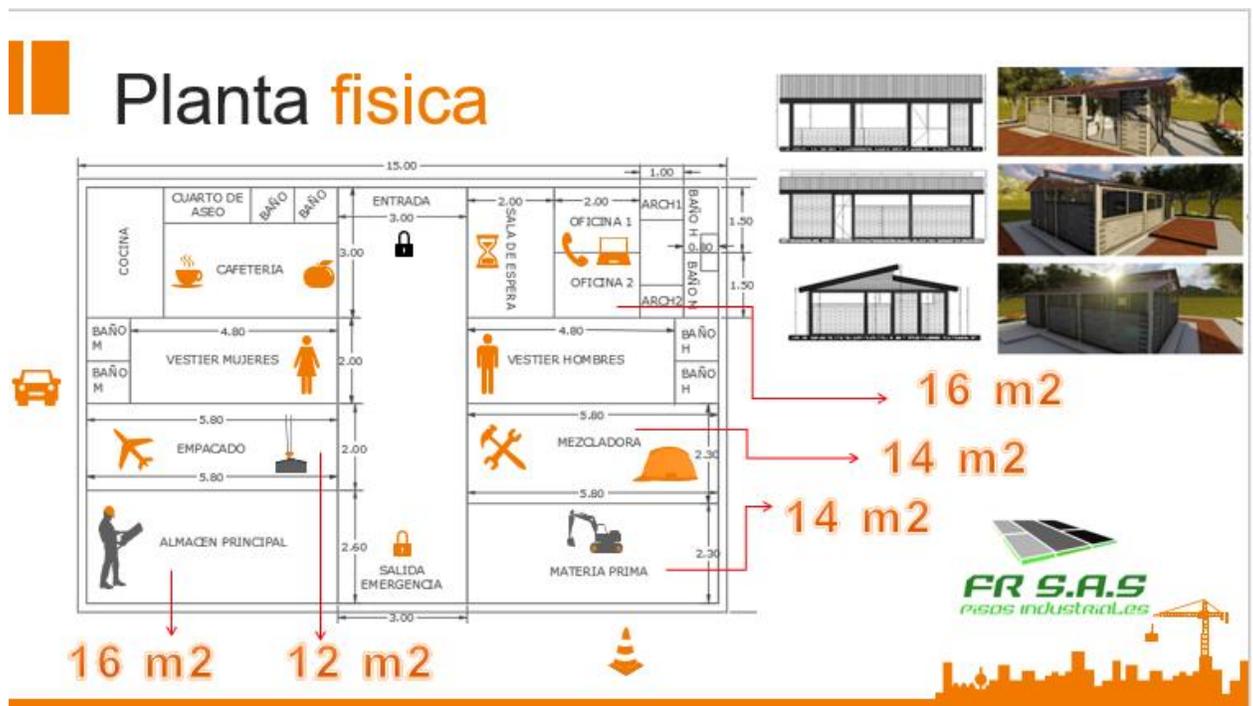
Planta arquitectónica de producción de micro concreto con grafeno.
